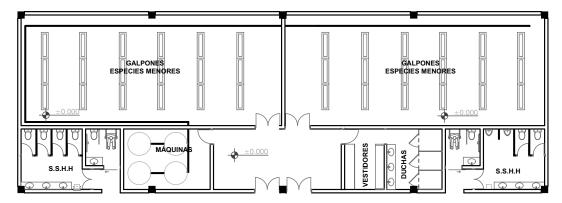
Planta Baja Zona Avicola Fuente: Autor
